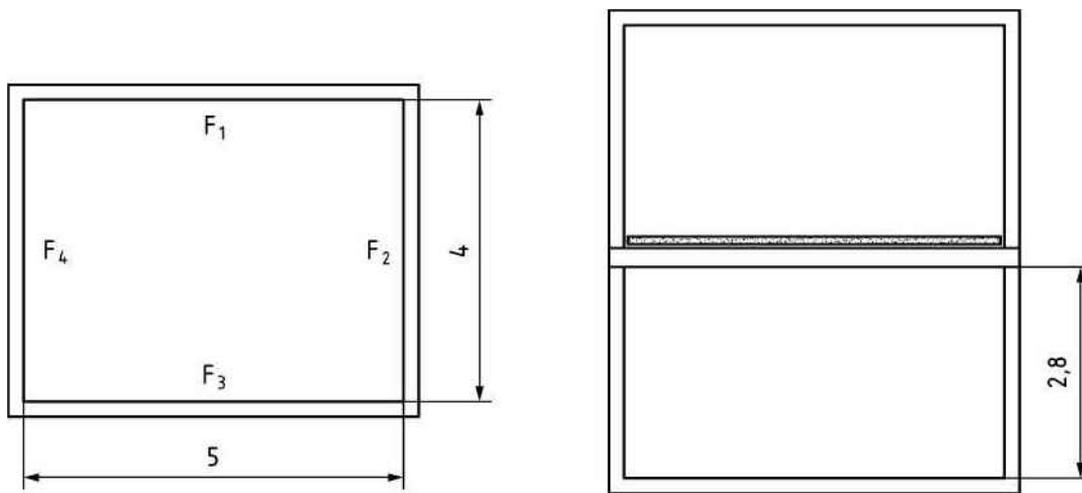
Grundriss (links) und Schnitt (rechts) zweier übereinanderliegender Räume im Holzbau (Prinzipskizze)
